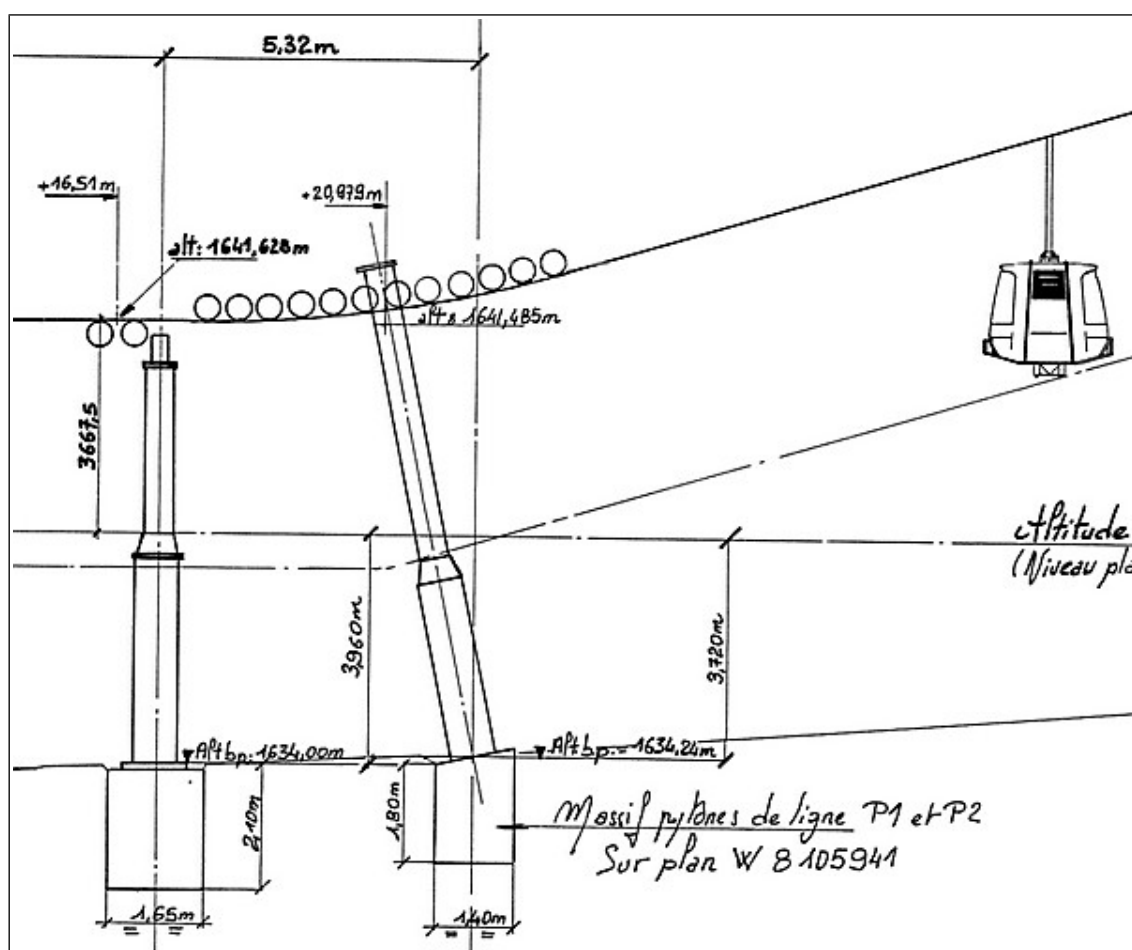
détail du plan d'implantation de la gare basse – zoom sur le pylône P1
